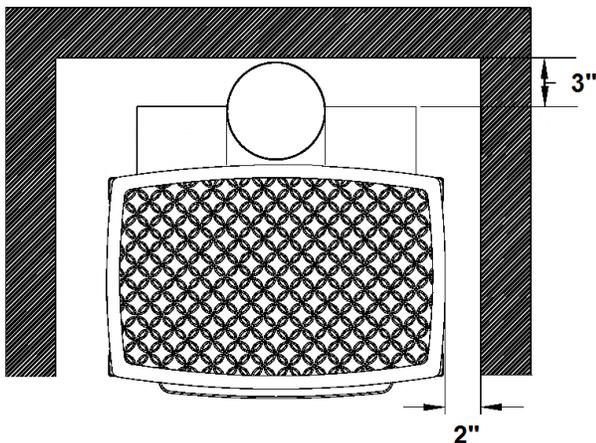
Dégagements Muraux Minimum Ventilation Horizontale
